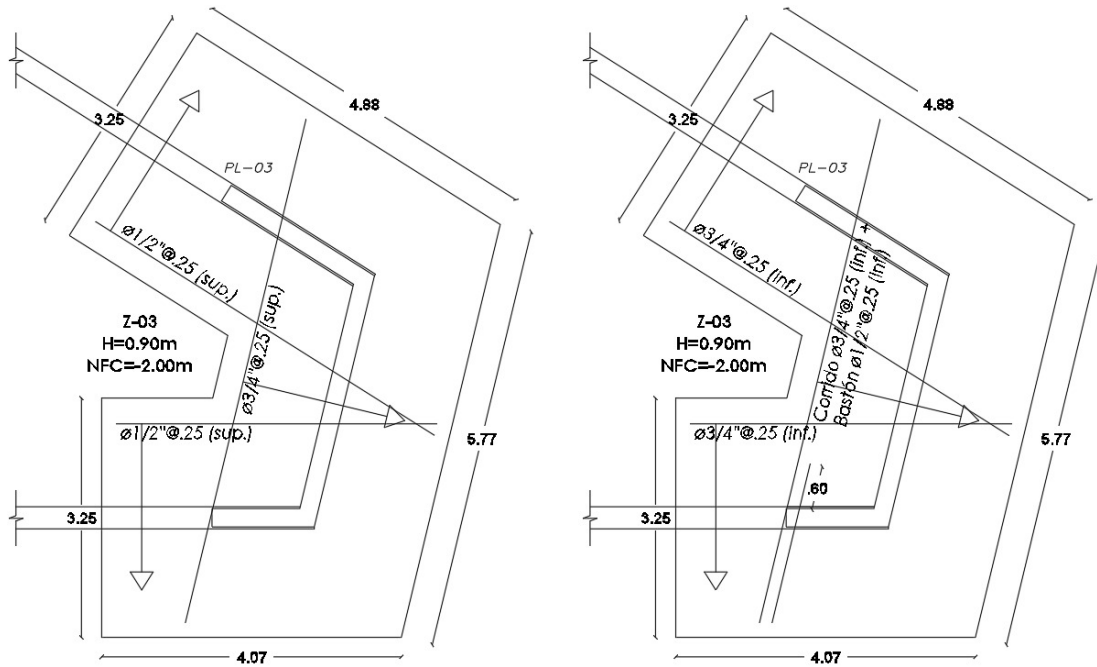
Disposición final de refuerzo longitudinal en zapata Z-03
